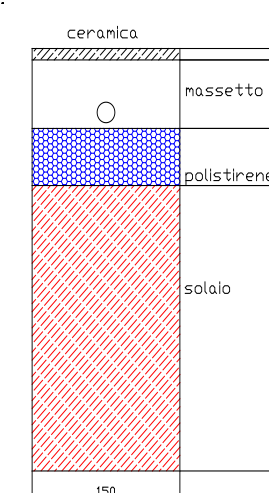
Pavimento radiante al piano terra (dimensioni in mm).
